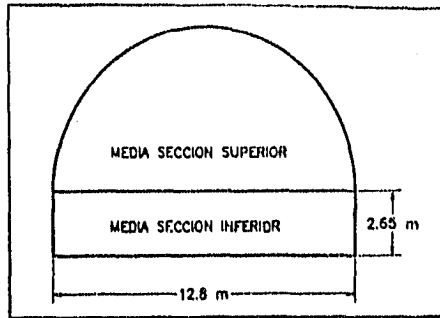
Sección transversal dividida en sección superior y sección inferior.
